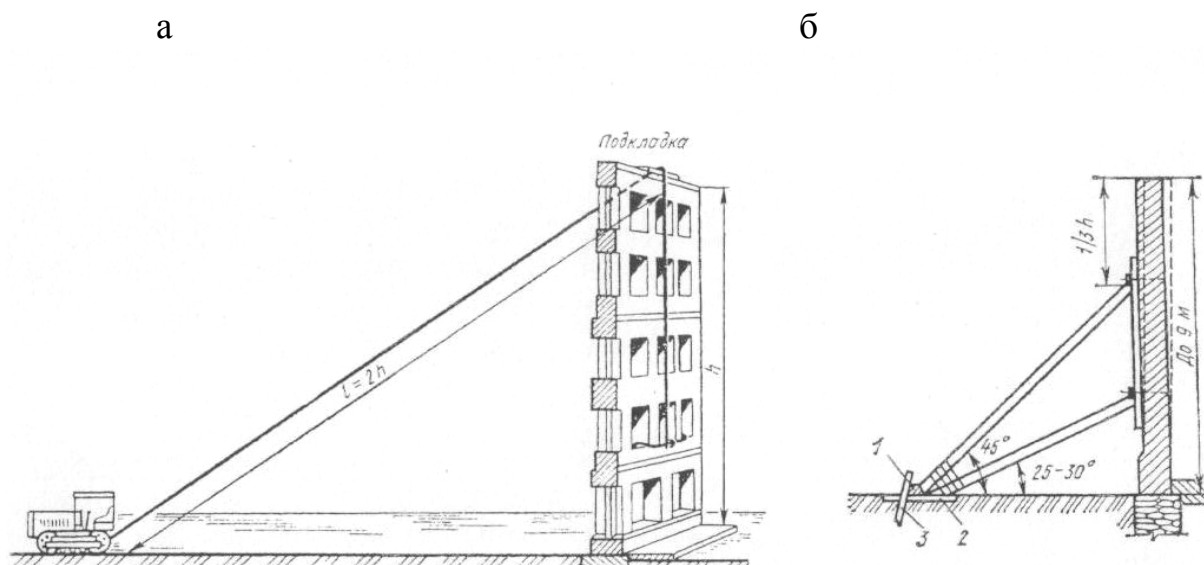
Обрушение (а) или укрепление (б) конструкций зданий
